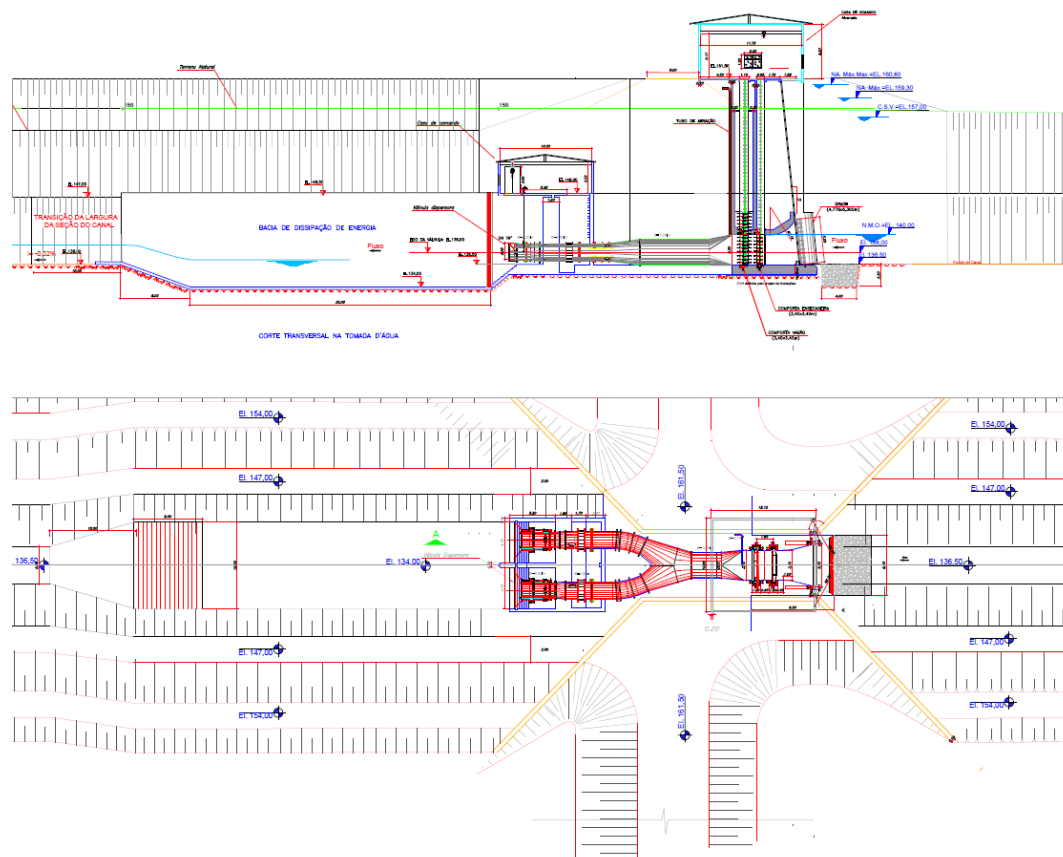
Arranjo das Estruturas – Planta Baixa e Perfil
